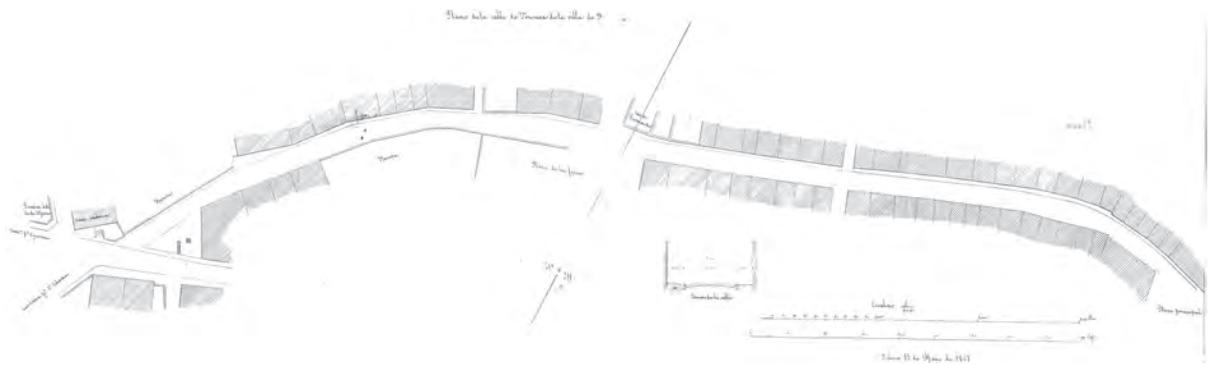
PLANO DEL PROYECTO DE EMPEDRADO DE LA C/ URUMEA EN 1864
